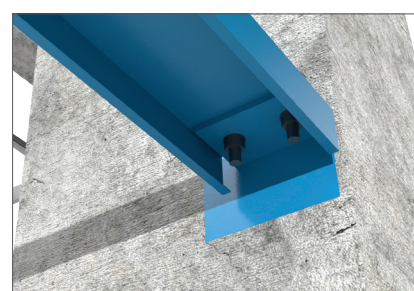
Provedení rámování otvorů pro okna u betonových skeletů
